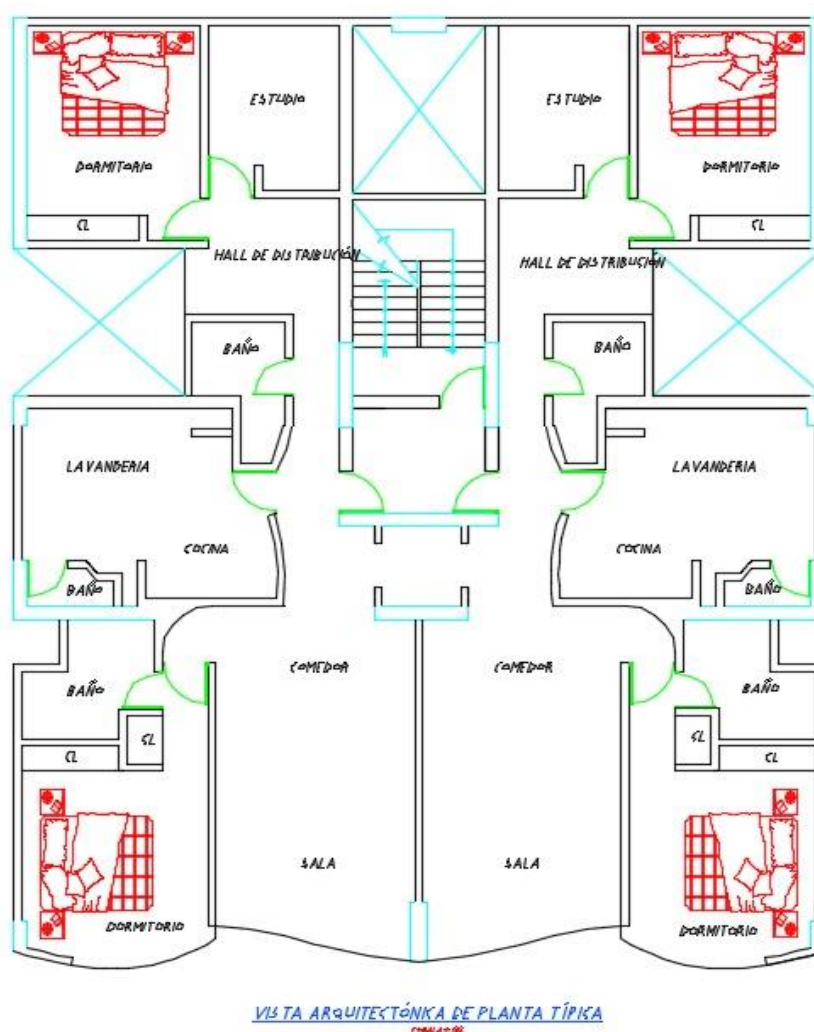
Plano de arquitectura típica que se usará en el proyecto para el modelamiento estructural. Fuente: (Blanco P., 2014)
